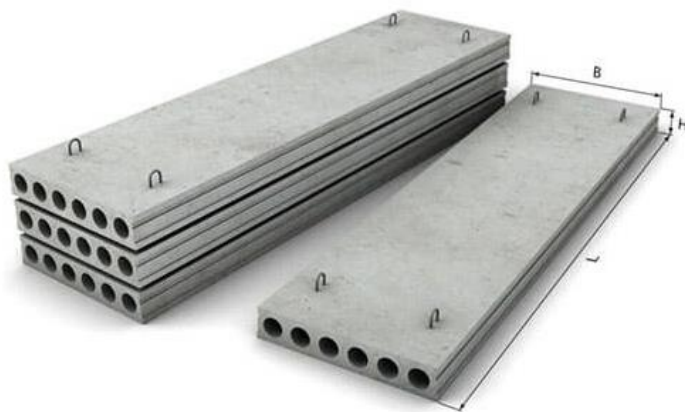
Збірні залізобетонні багатопустотні плити
